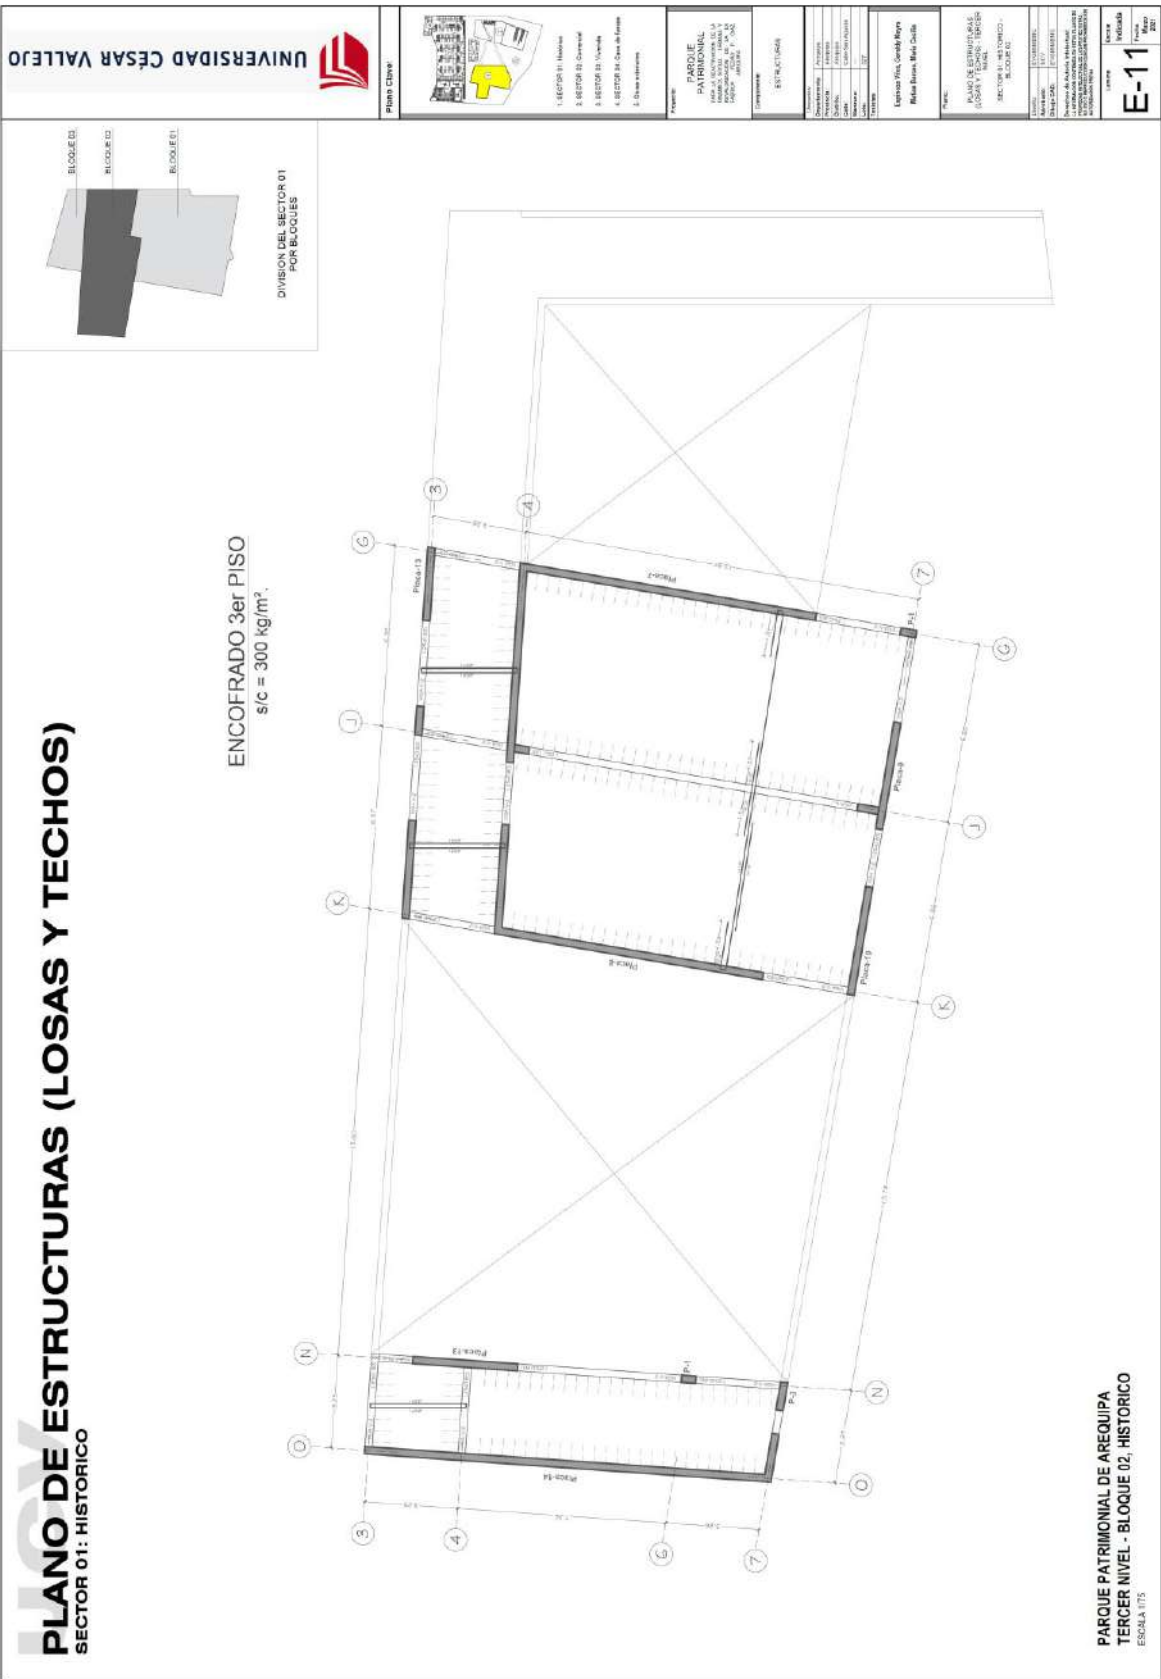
Plano de estructuras (losas y techos) Sector 1 - Bloque 02.
